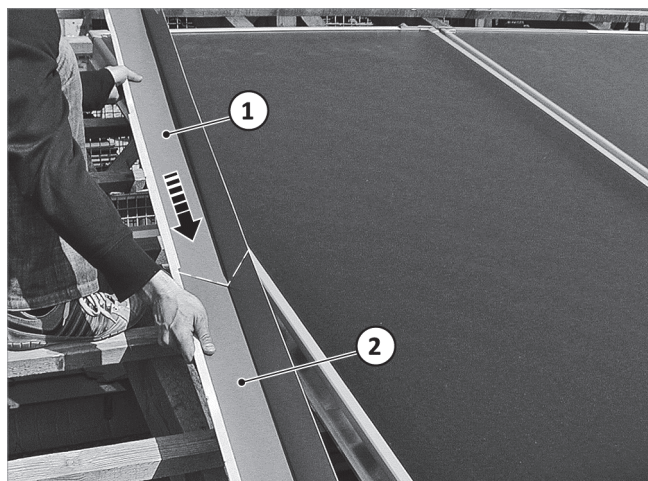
pousser la tôle latérale sur la partie inférieure
